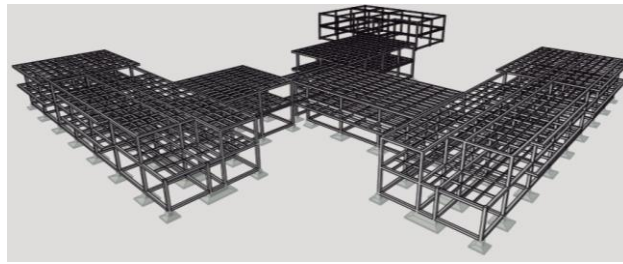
sistema modular y estructural del proyecto zapatas aisladas
